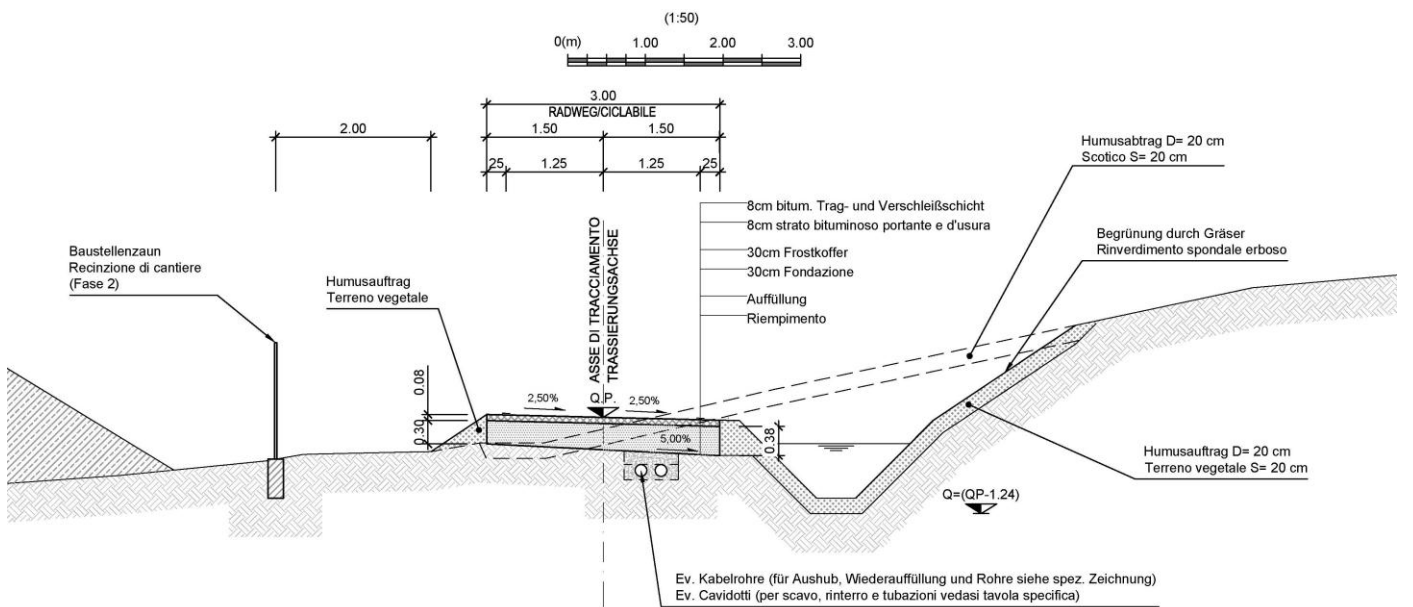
Regelquerschnitte Fahrradweg Baustelle Genauen 2 – Endstrecke
